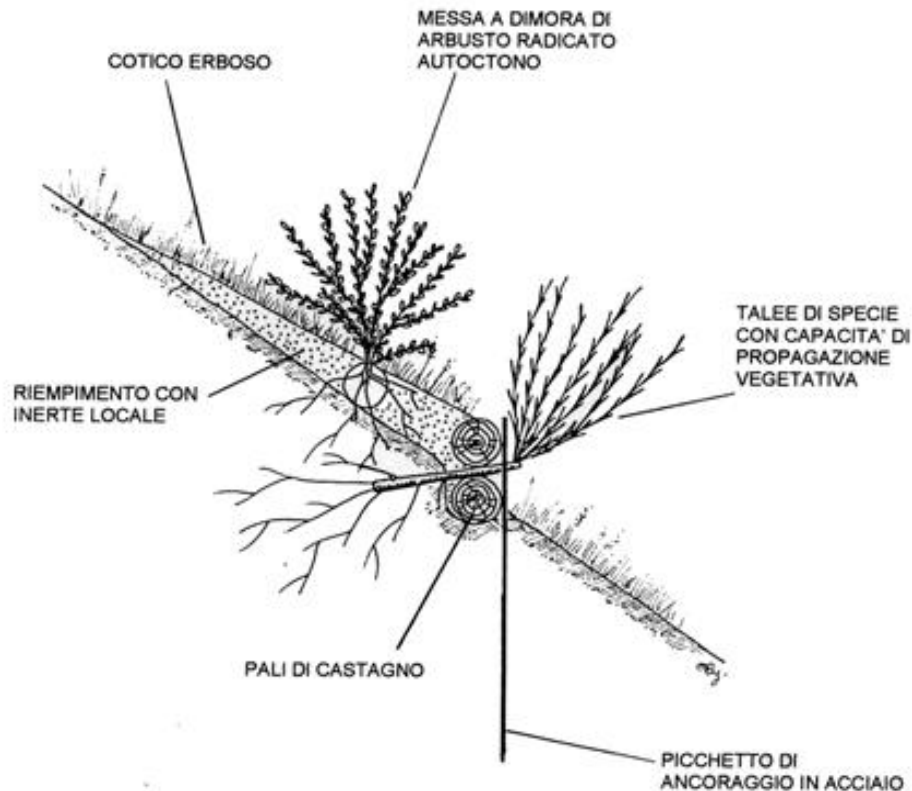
Sezione tipo di palizzata viva di sostegno a doppio palo.
